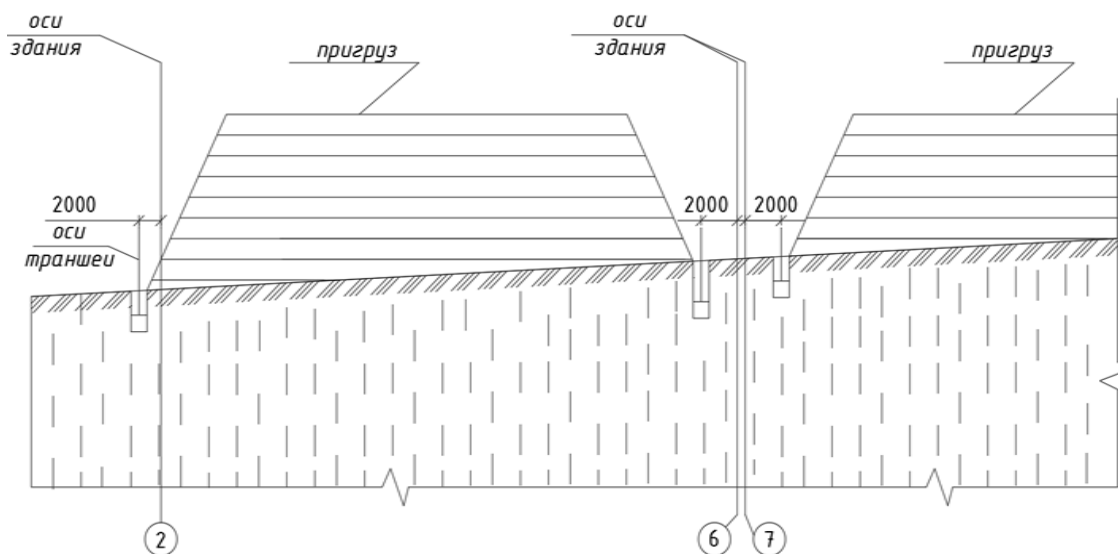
Схема уплотнения просадочных грунтов предварительным замачиванием с устройством пригрузки
